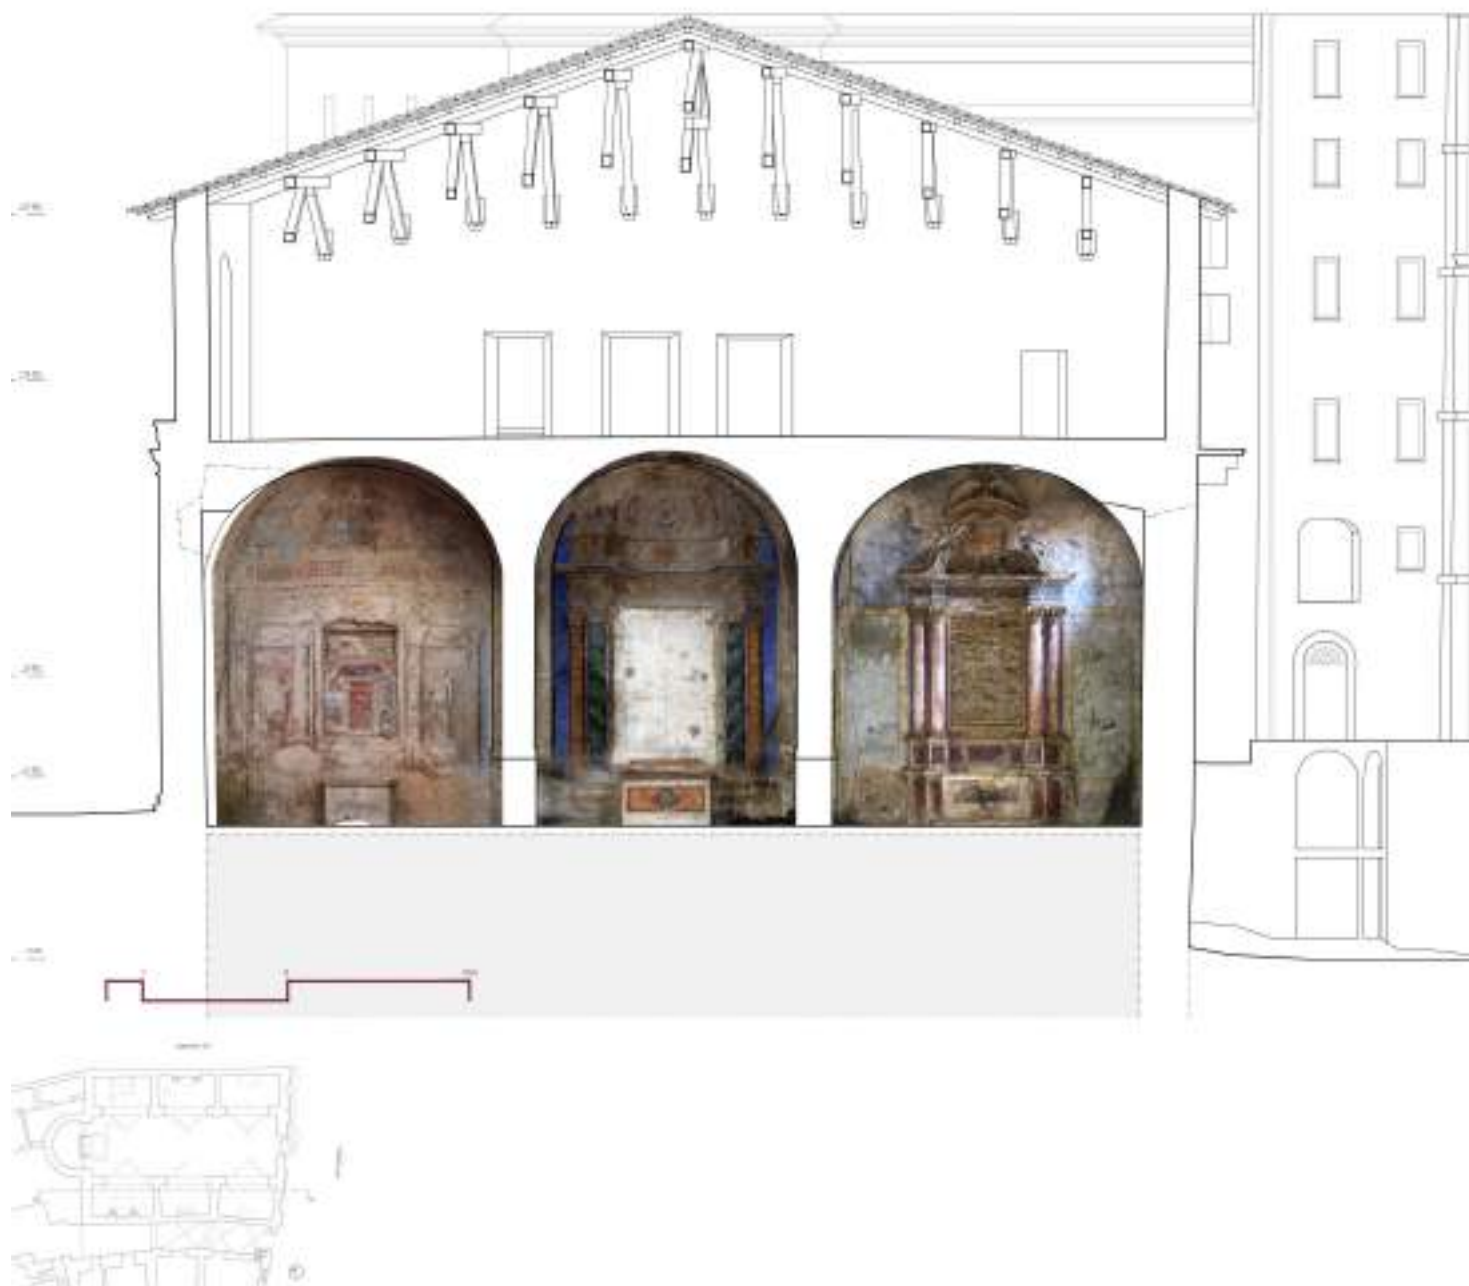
/ Sezione longitudinale FF' con ortofoto.
